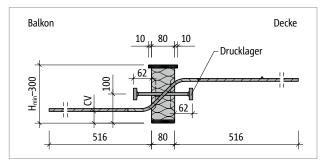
Schöck Isokorb® T Typ QP-V5: Produktschnitt
